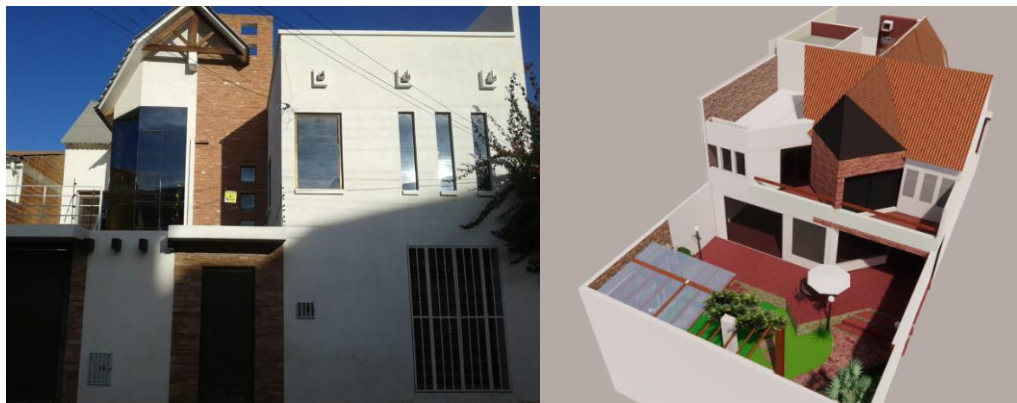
Izquierda: Fachada Norte. Der: fachada Sur de la de la vivienda. Elaboración propia, 2023.
